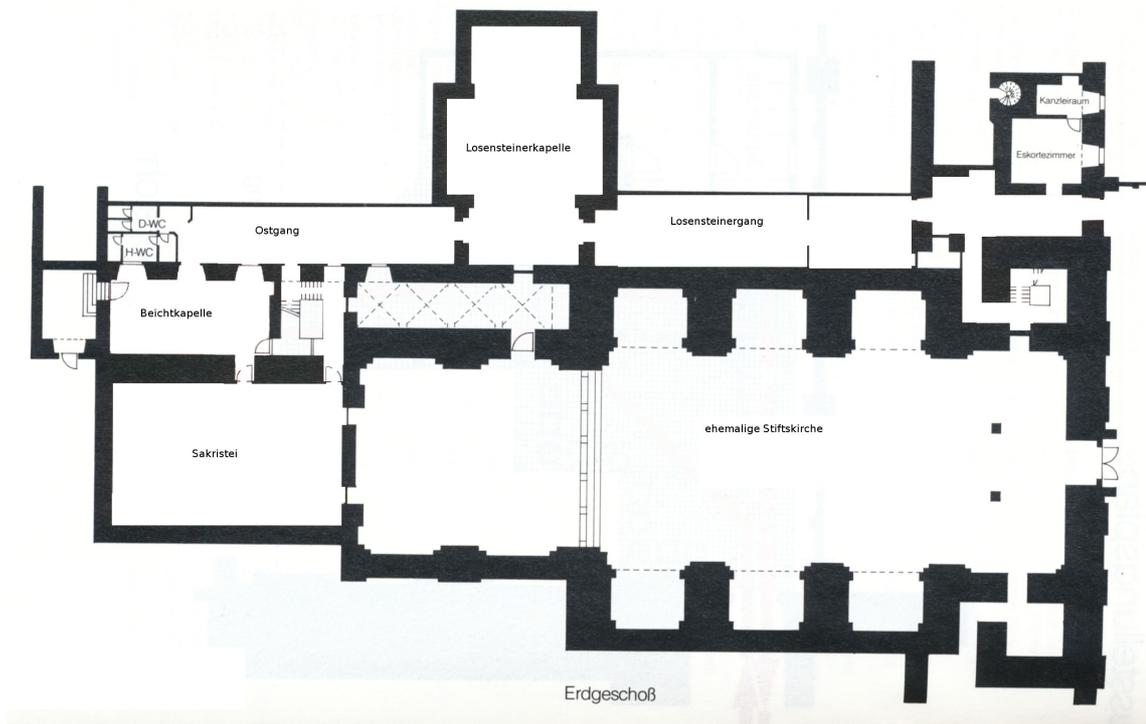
Grundriss Stiftskirche mit im Osten und Süden angrenzenden Gebäuden.
